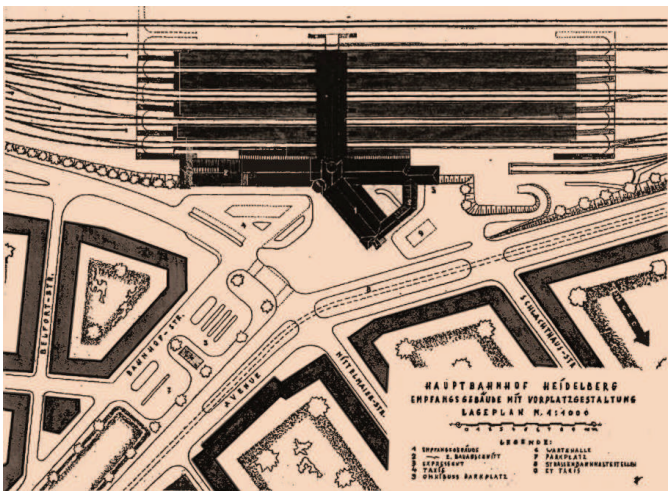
Lageplan Empfangsgebäude, Abb. 3: Empfangshalle, 1957
